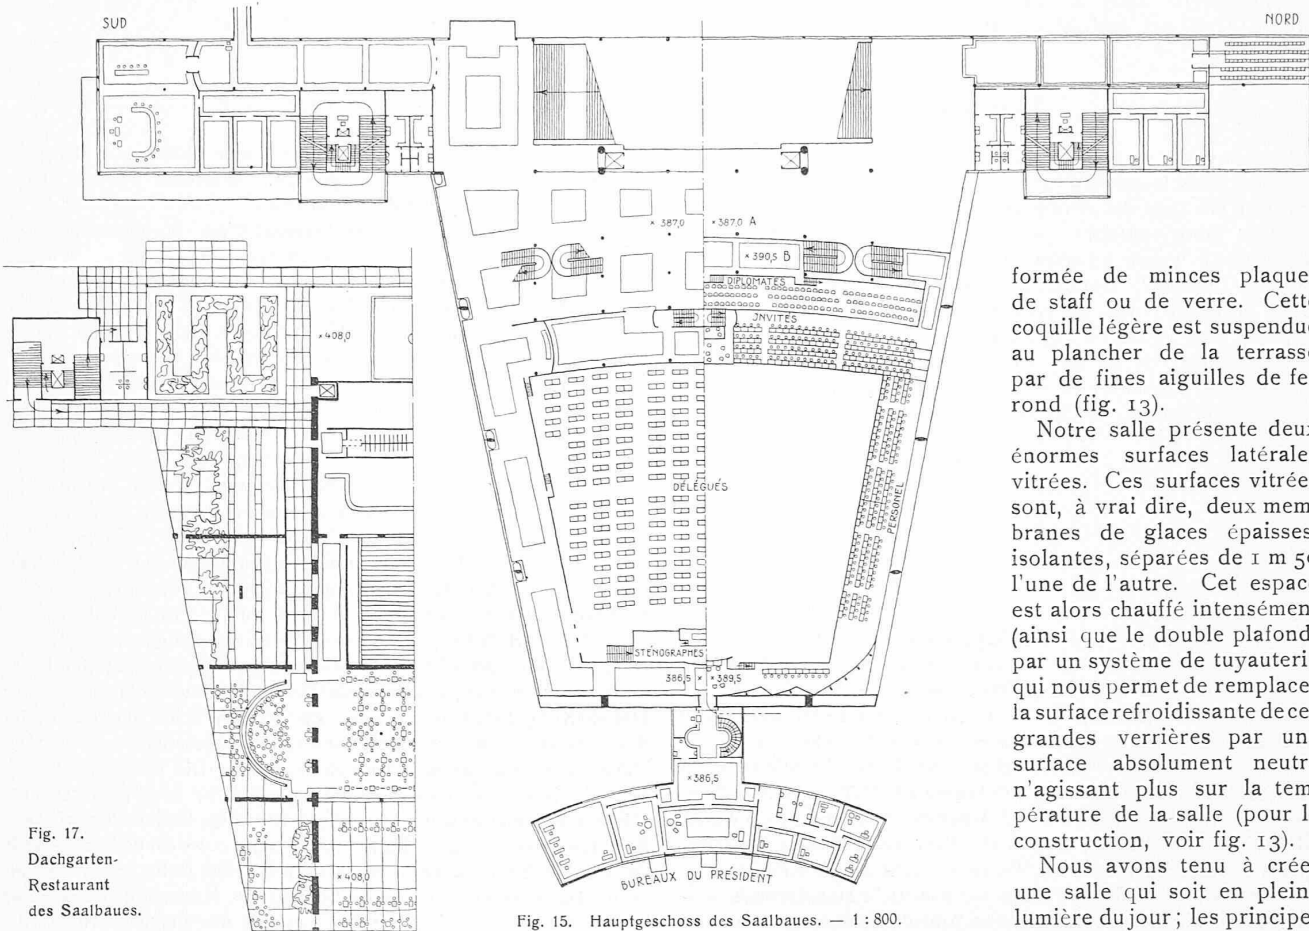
Dachgarten-Restaurant des Saalbaues.
